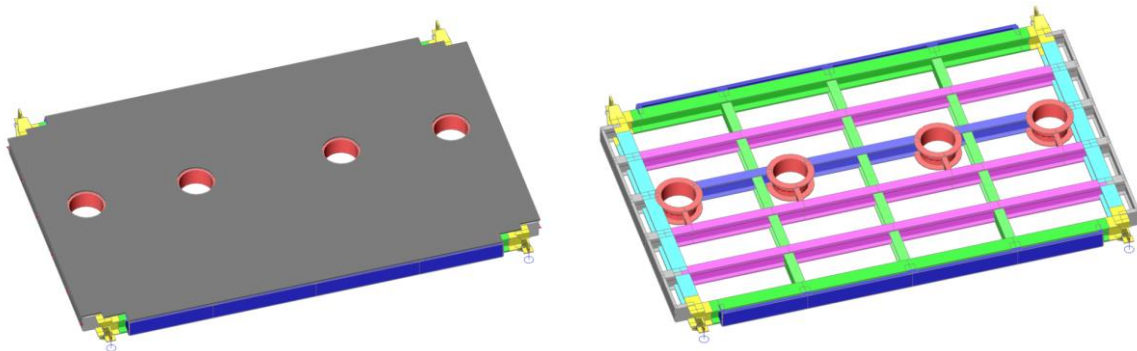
Modèle type 1 mixte avec dalle 2D modélisée en plaques et poutres filaires
